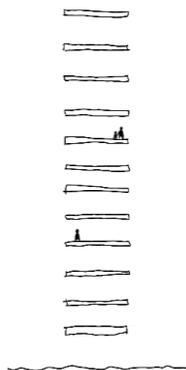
La característica principal de la construcción en altura es la superposición de planos horizontales
